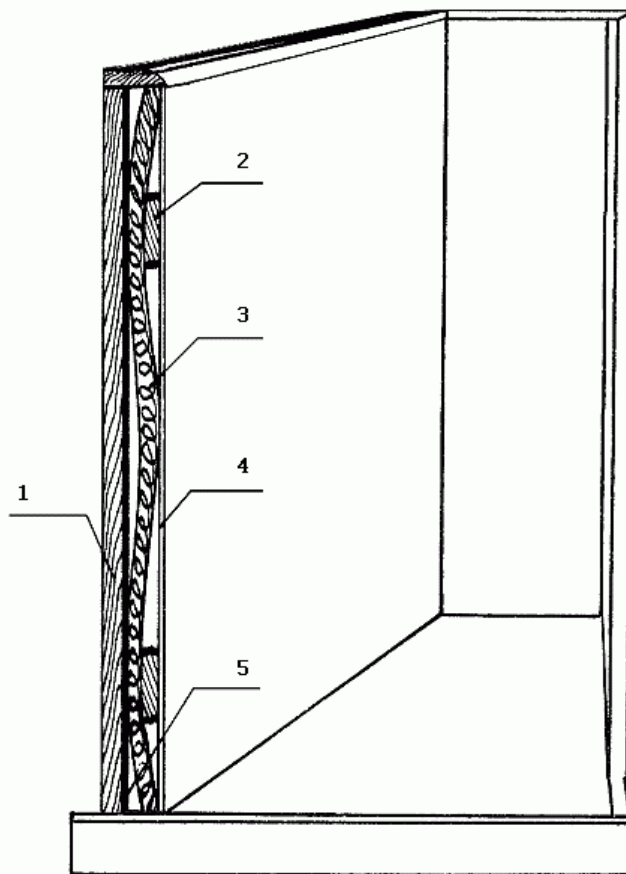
Конструкция легкой «слоеной» стены: 1 – опорный брус; 2 – рейка обшивки; 3 – утеплитель; 4 – внутренняя обшивка стены; 5 – пароизоляция
